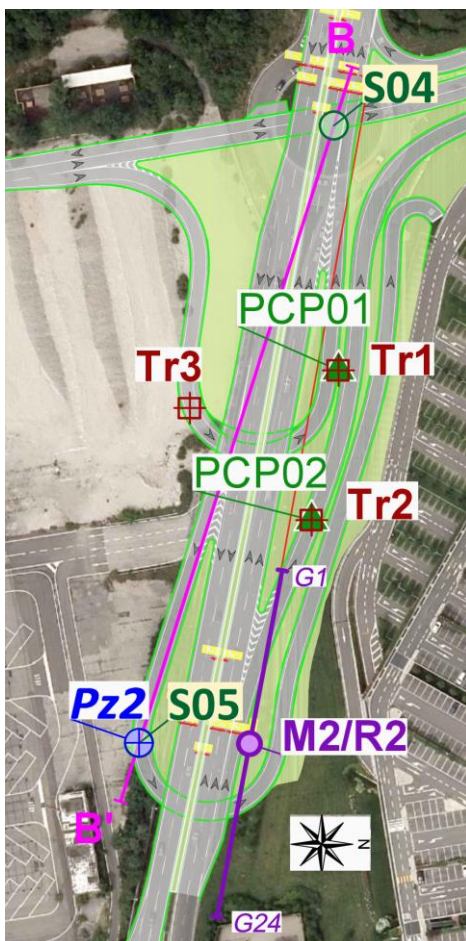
Schema planimetrico con traccia sezione geologica B-B'
